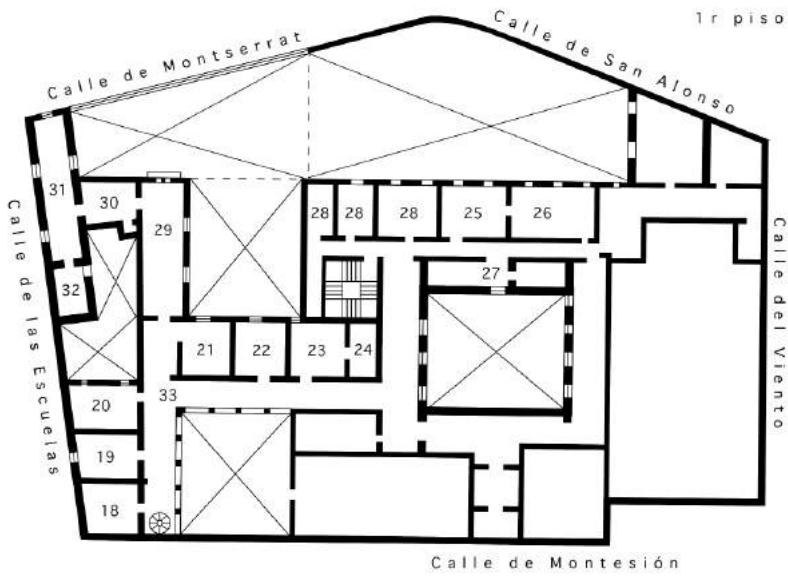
Plano II. Primera Planta del edificio de Montesión.
